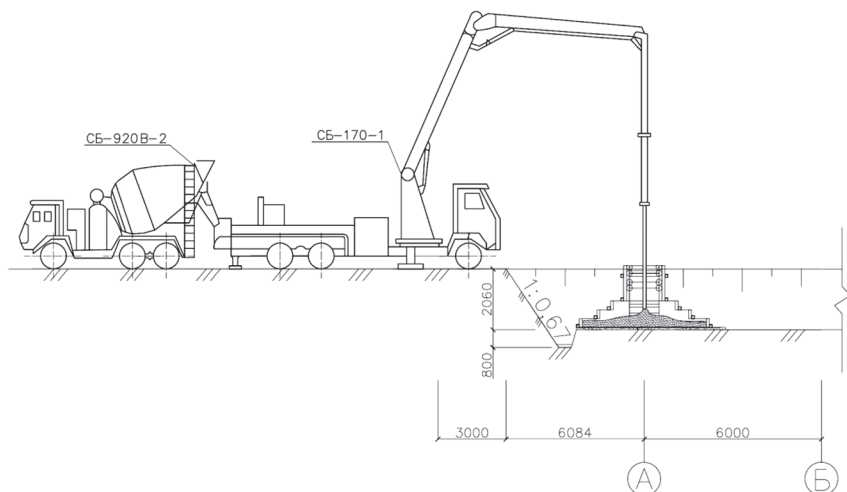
Схема производства работ при бетонировании монолитного фундамента
